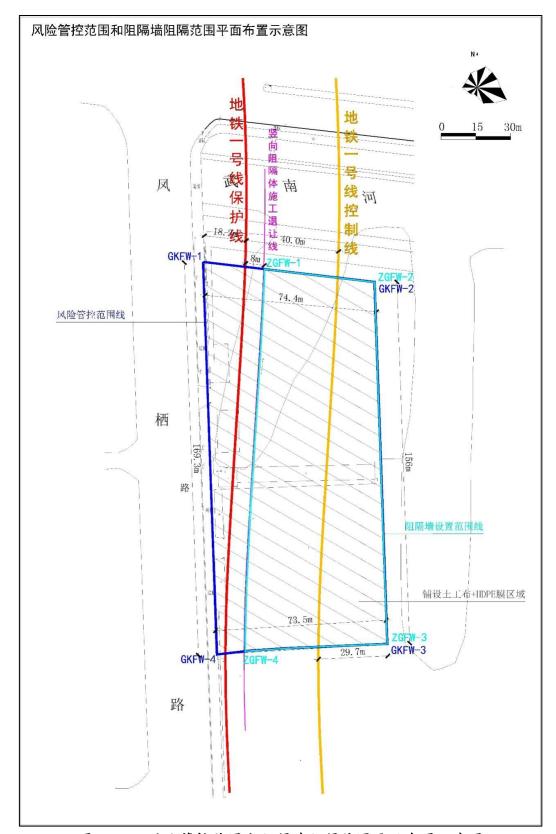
风险管控范围和阻隔墙阻隔范围平面布置示意图
